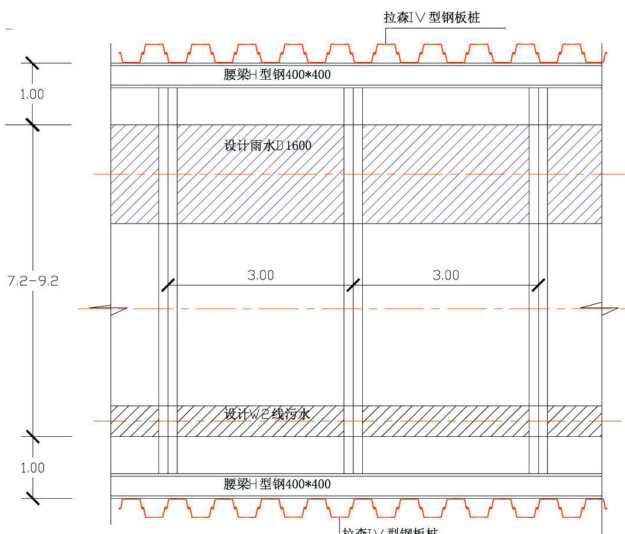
+ 460- 终点段拉森钢板桩支护结构平面图
